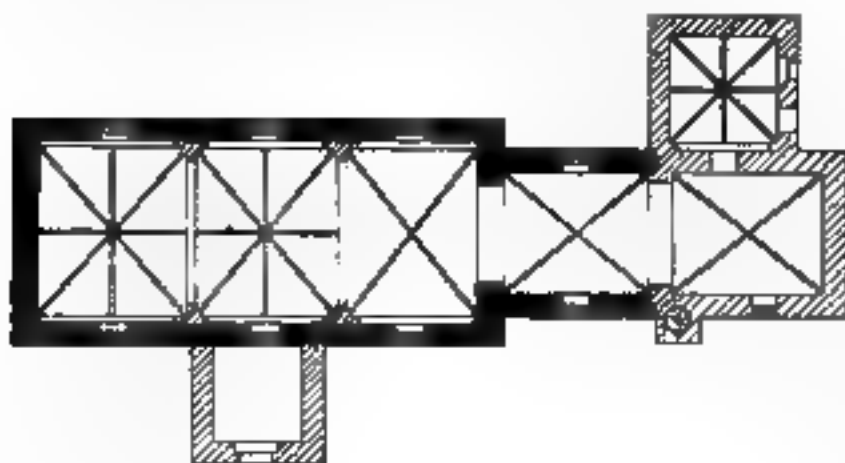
Grundriss der Kirche zu Stepping. (S. Seite 379.)
